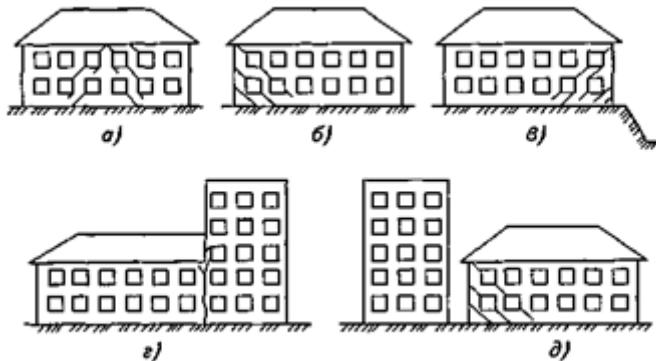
Причины образования трещин в несущих стенах из-за неудовлетворительного состояния оснований и фундаментов:
